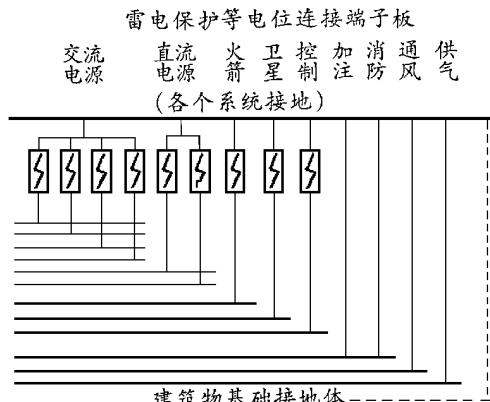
钢筋混凝土卫星发射塔架防雷等电位连接示意
